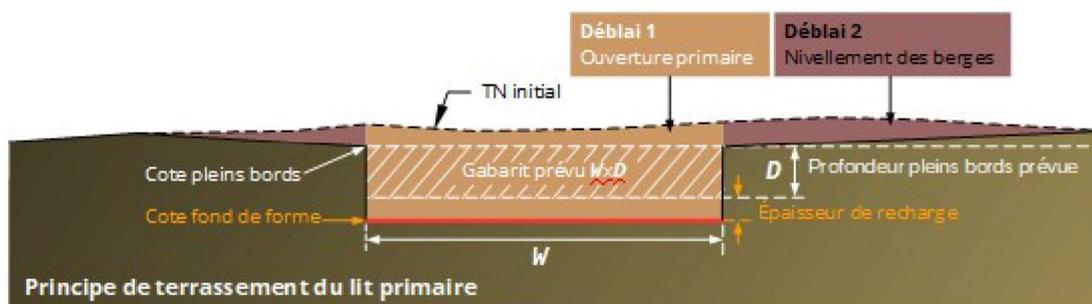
Profil type – principe de rectification de la hauteur pleins bords
